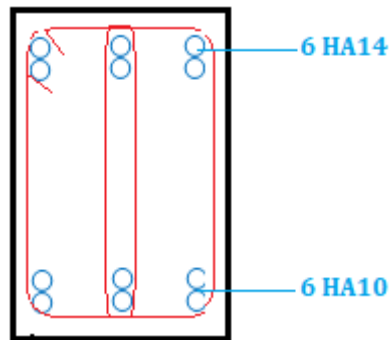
Coupe du schéma de ferrailage de la poutre.
